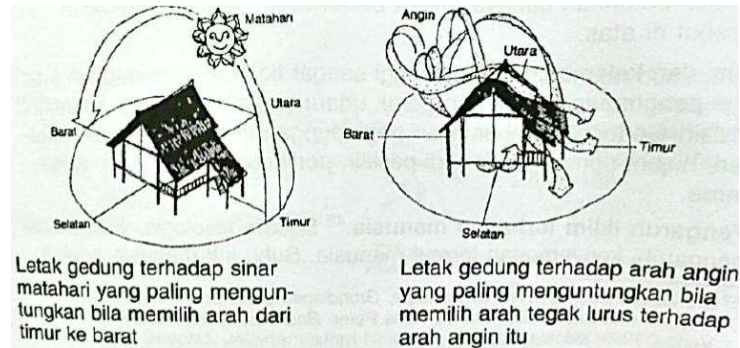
4 Penataan Massa Bangunan Terkait Sirkulasi Udara
